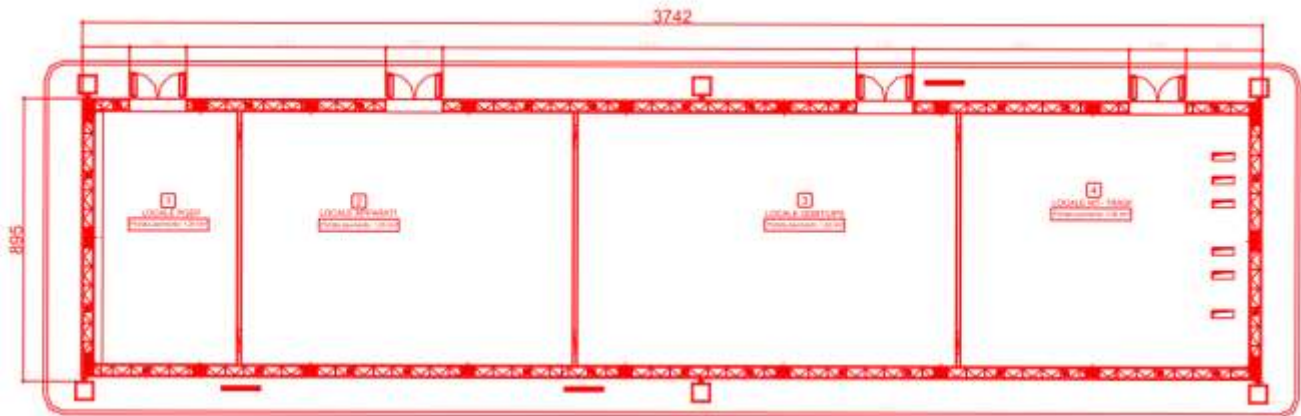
Pianta piano terra del fabbricato FA1L nel Progetto di variante.
